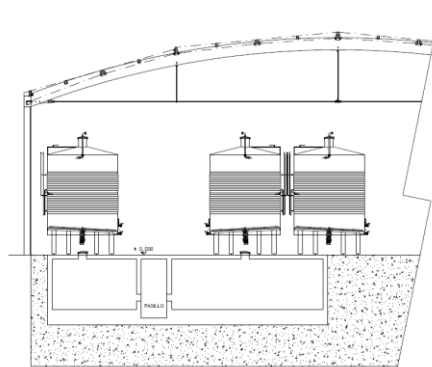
Esquema de implantación de depósitos autovaciantes sobre depósitos subterráneos de hormigón armado. Cooperativa de Borja (Zaragoza). Año de construcción 2004.
